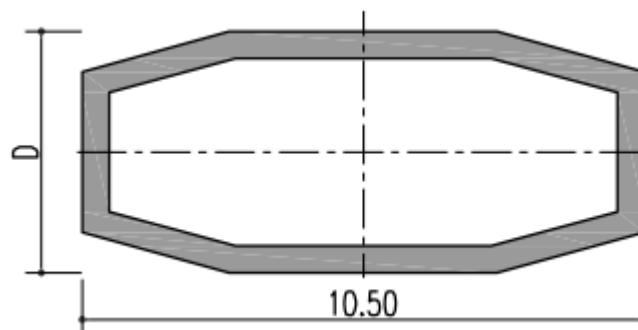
Secção transversal corrente dos pilares [22].
